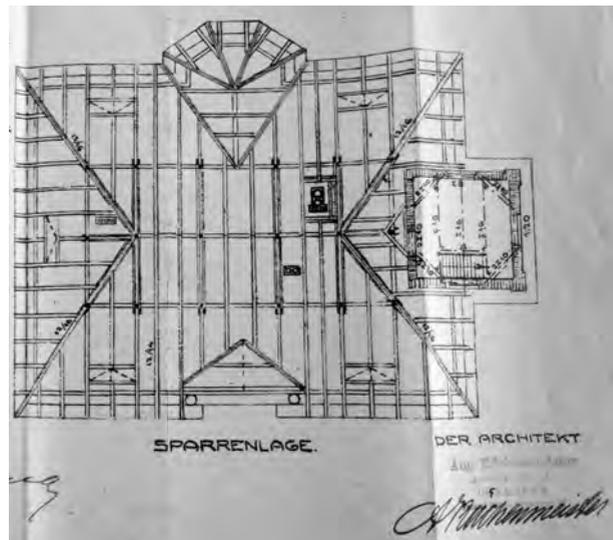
Sparrenlage der Dachkonstruktion mit Mauerkranz des Hausvorbaus; Ostseite; sowie der eingezeichneten Dachgaubenkonstruktionen⁷⁶
